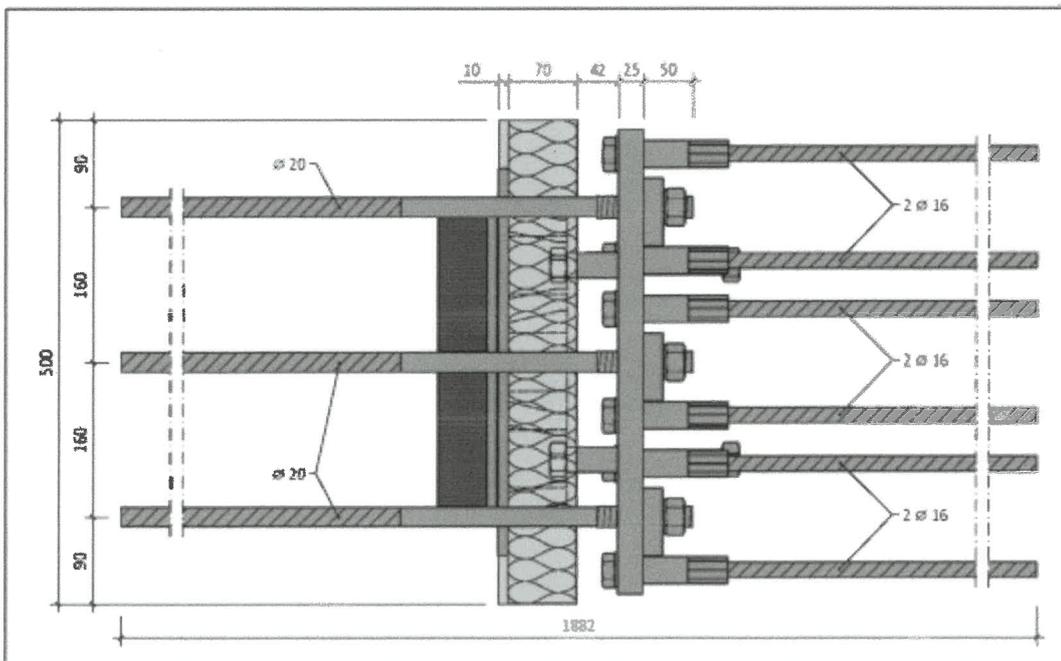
Schöck Isokorb® IQ Typ K: Produktgrundriss
